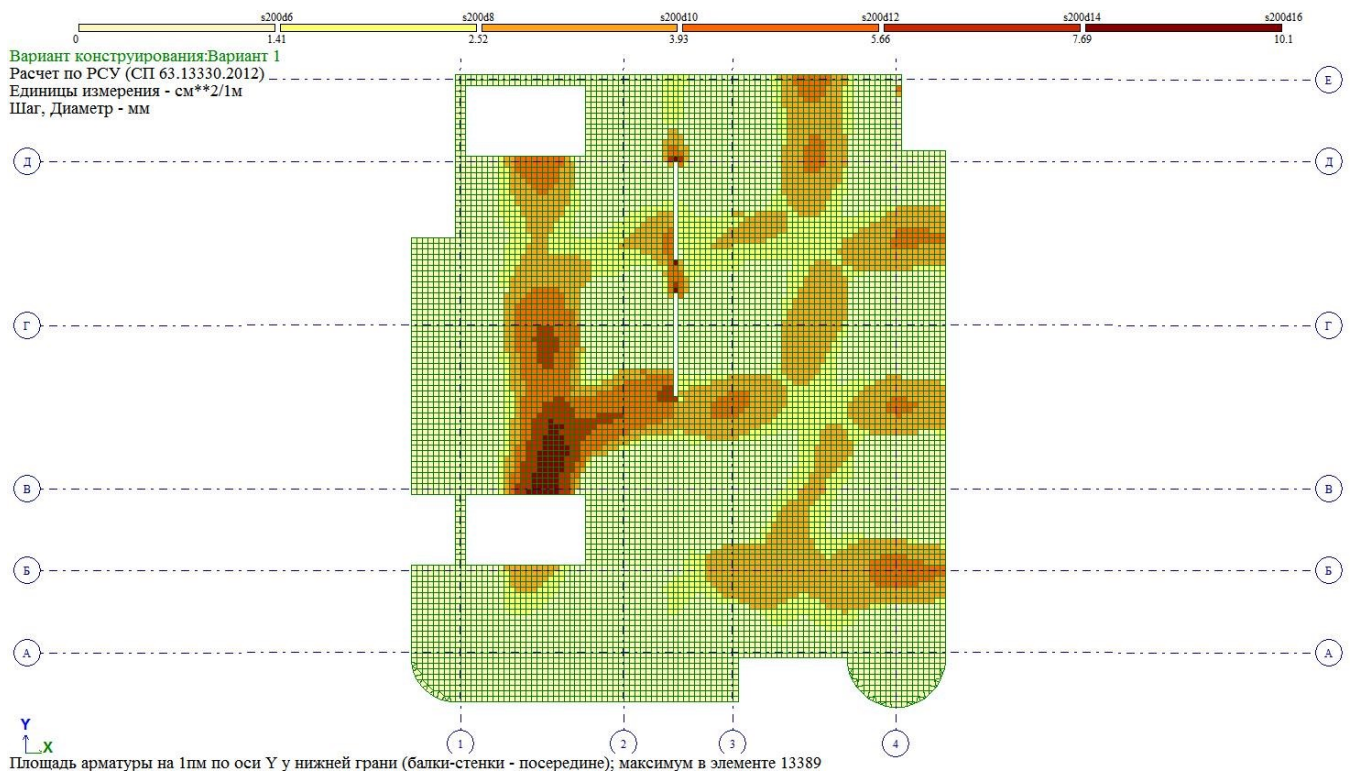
Площадь арматуры по оси Y у нижней грани
